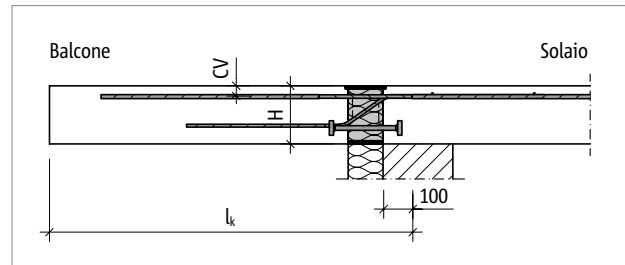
Schöck Isokorb® XT tipo KP-M11: schema statico
